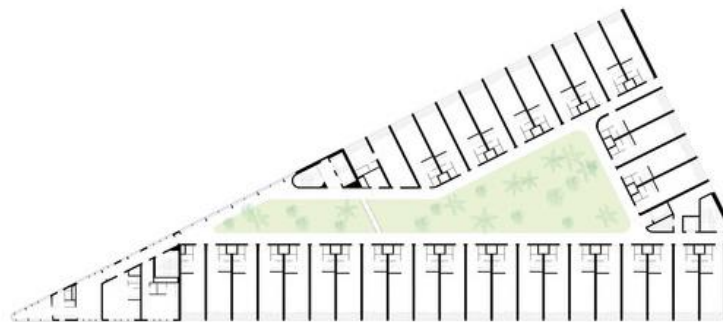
Planta do pavimento térreo Hotel Jakarta
